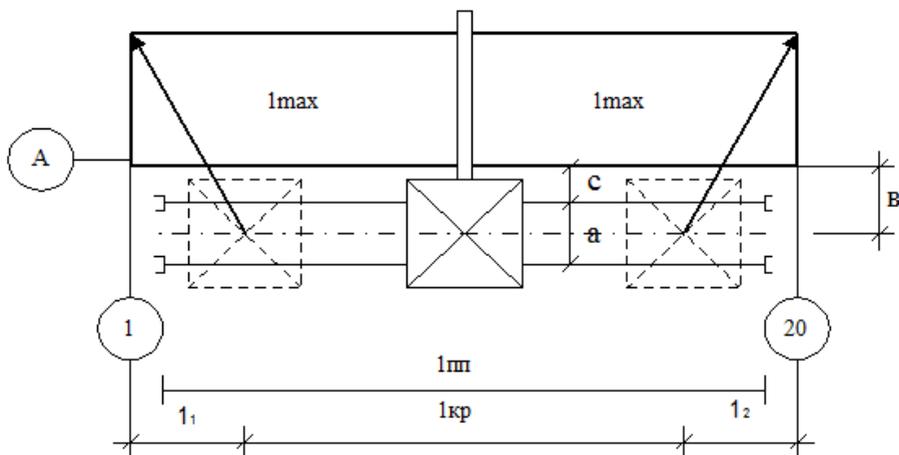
Схема продольной привязки башенного крана и подкрановых путей к зданию
